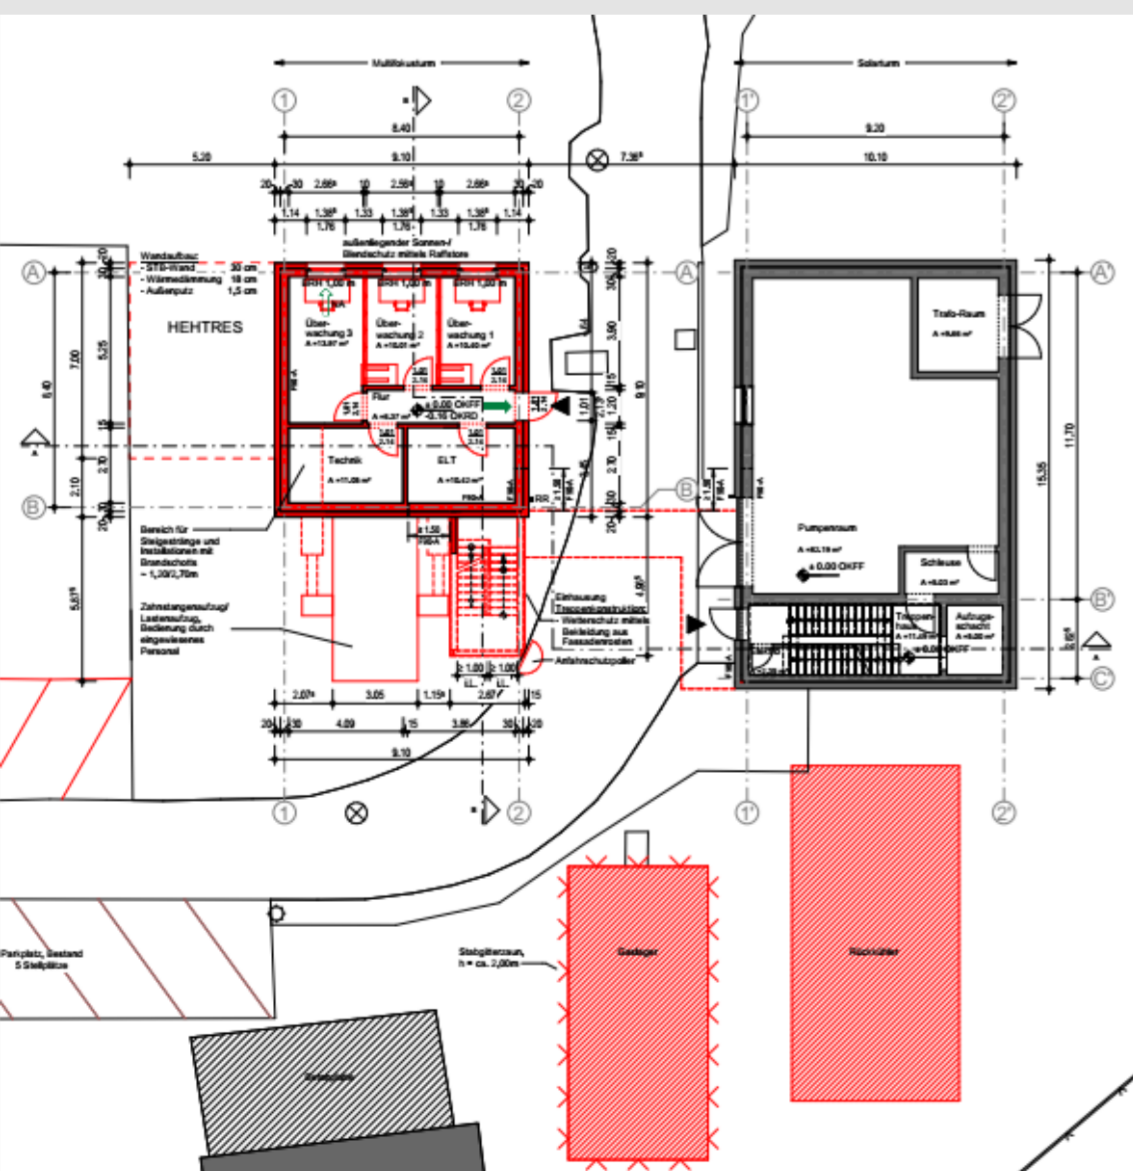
Lageplan des Geländes um den Multifokus Jülich und den bestehenden Solarturm
